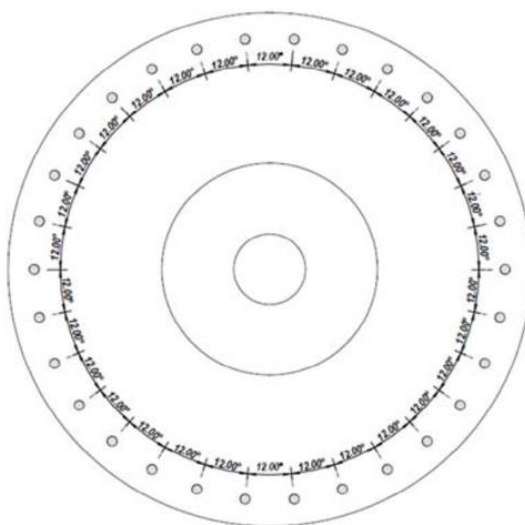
Andamento geometrico della fondazione (pianta – non in scala).
